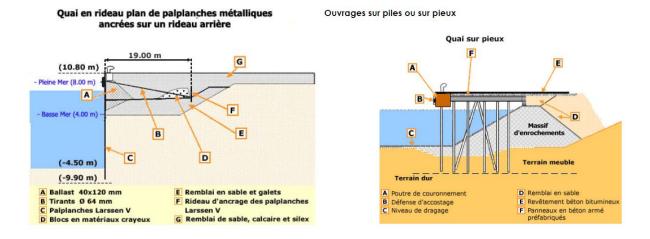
Constitution des quais en rideau (palplanches) ou quais sur pieux.
